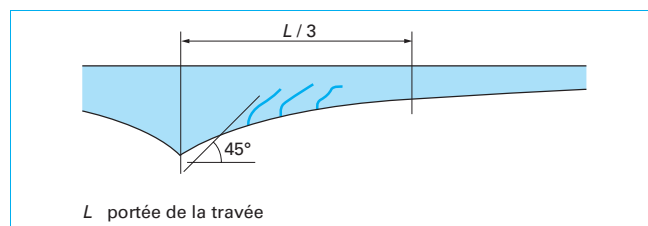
Fissuration d'effort tranchant dans un pont-caisson
